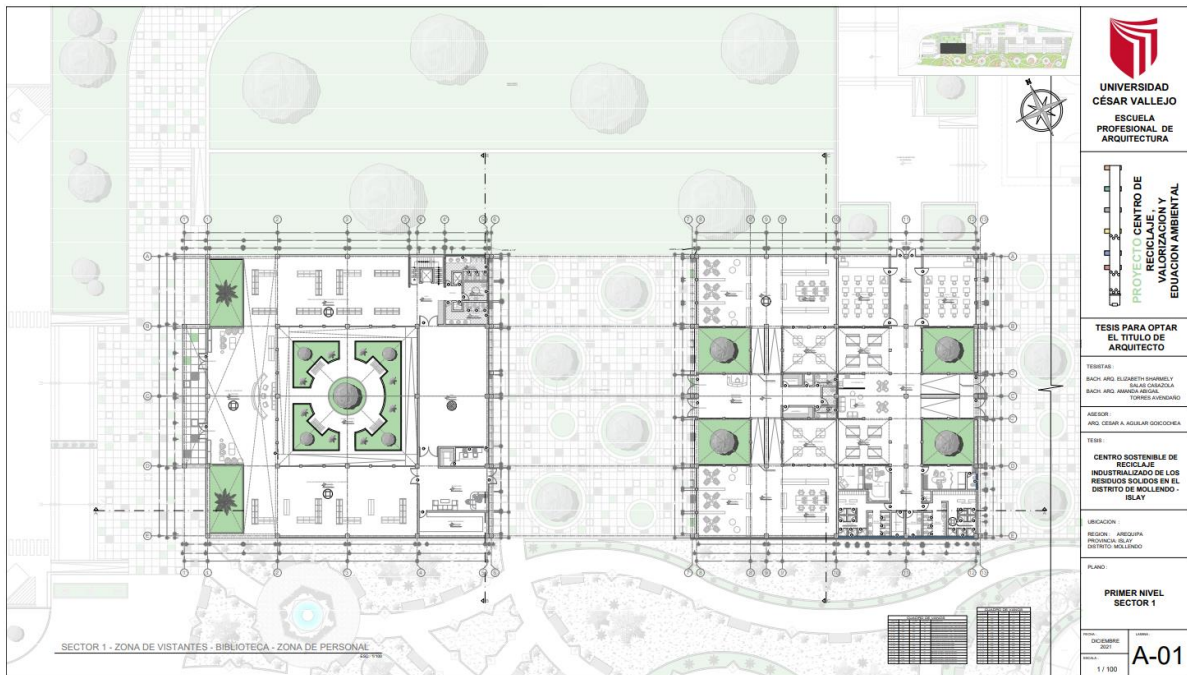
Planta de Distribución, Sector 1 – Primer Nivel
